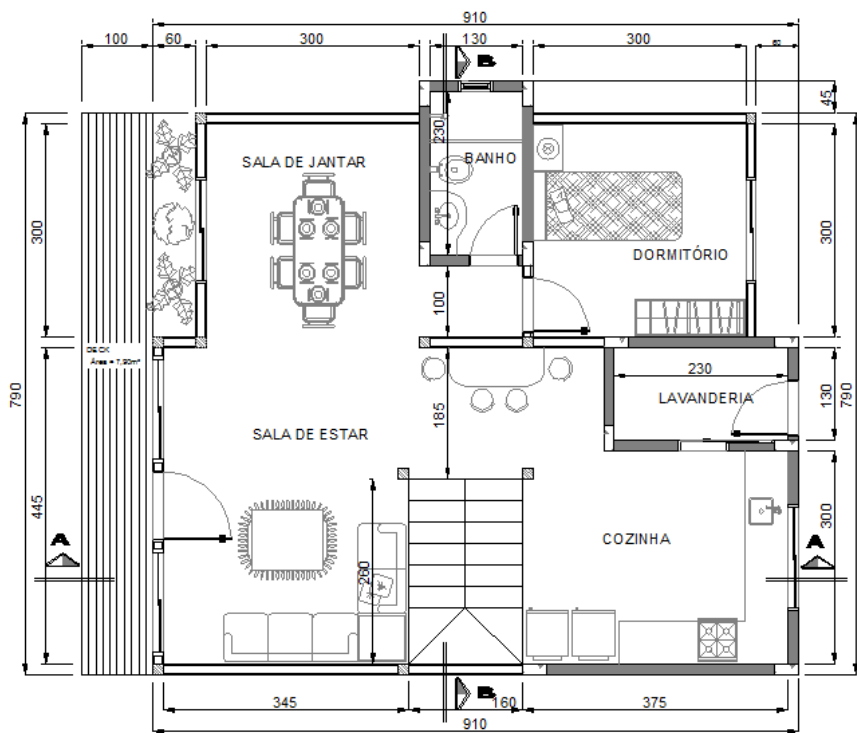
Planta baixa do térreo - sem escala. Fonte: do autor
